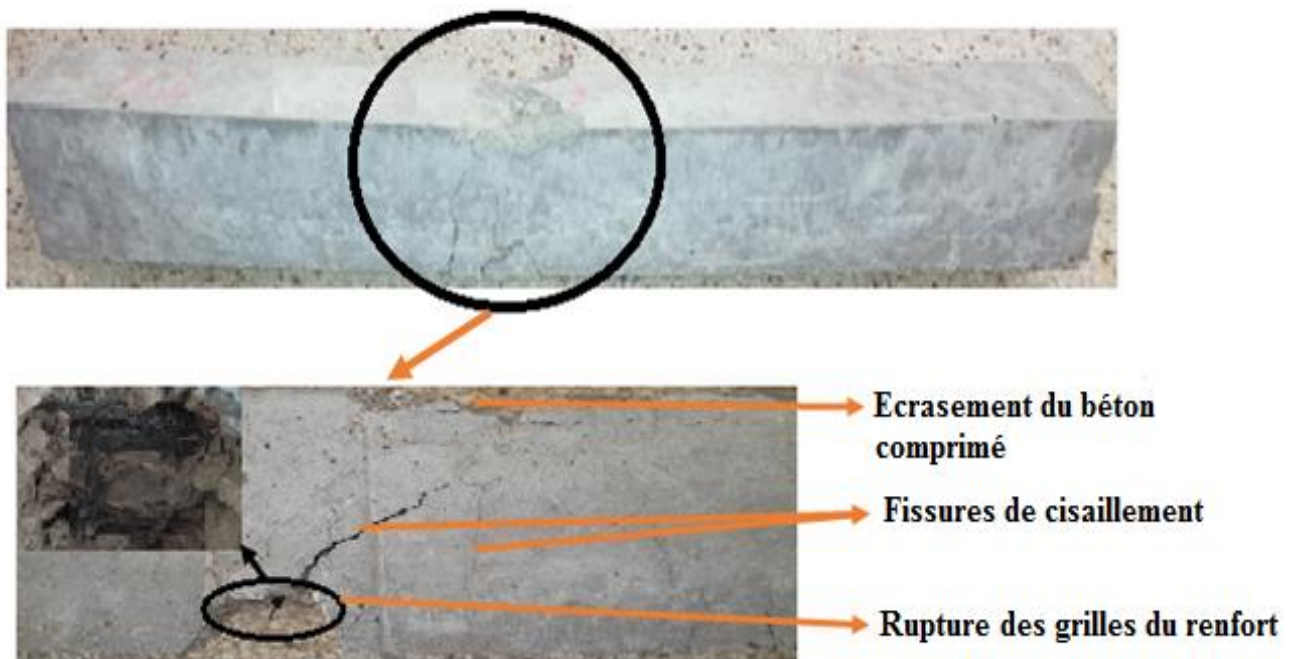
Exemple de mode de rupture des poutres renforcées du groupe 01 et 02
